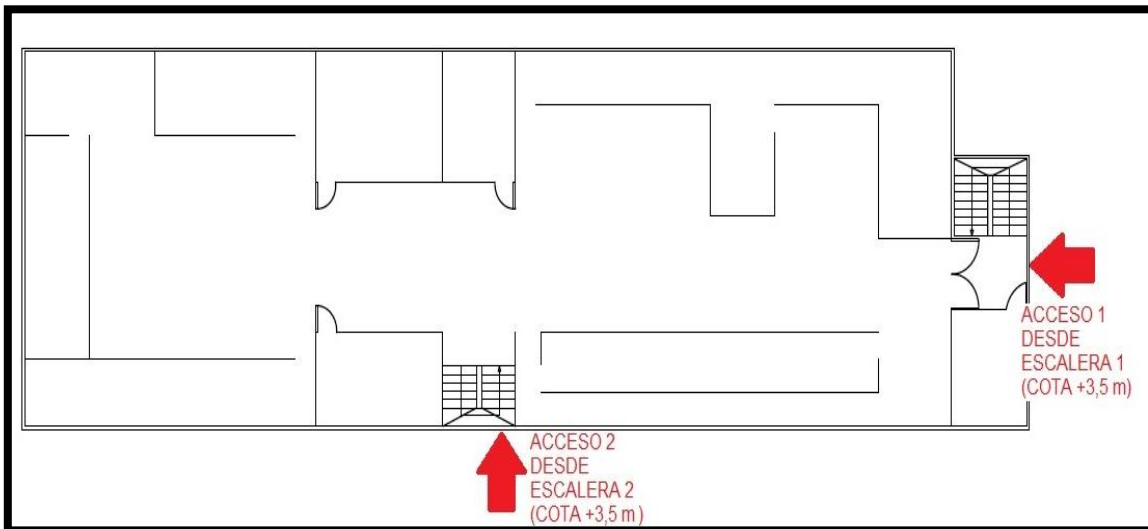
“Vista en planta de accesos a segundo piso (cota +3.50) de la discoteca 2.”
